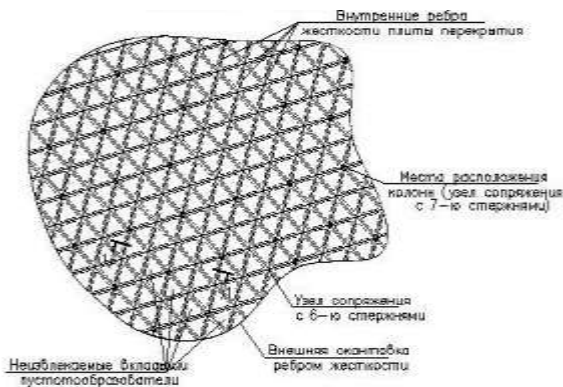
Конструкция фундаментной плиты с колоннами первого этажа
